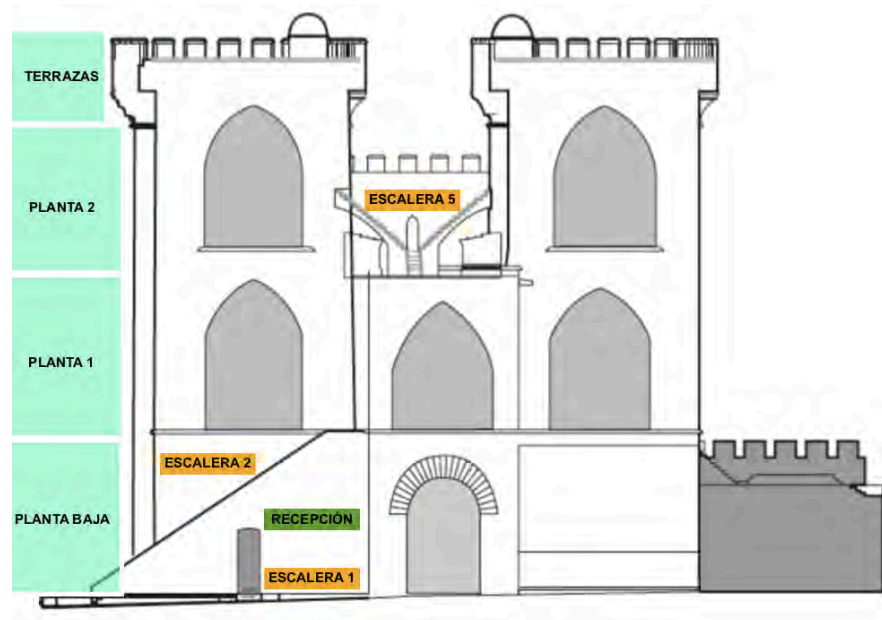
Alzado posterior de las Torres indicando plantas estudiadas y escaleras (Fuente: www.museosymonumentosvalencia.com Plano modificado por el autor)
